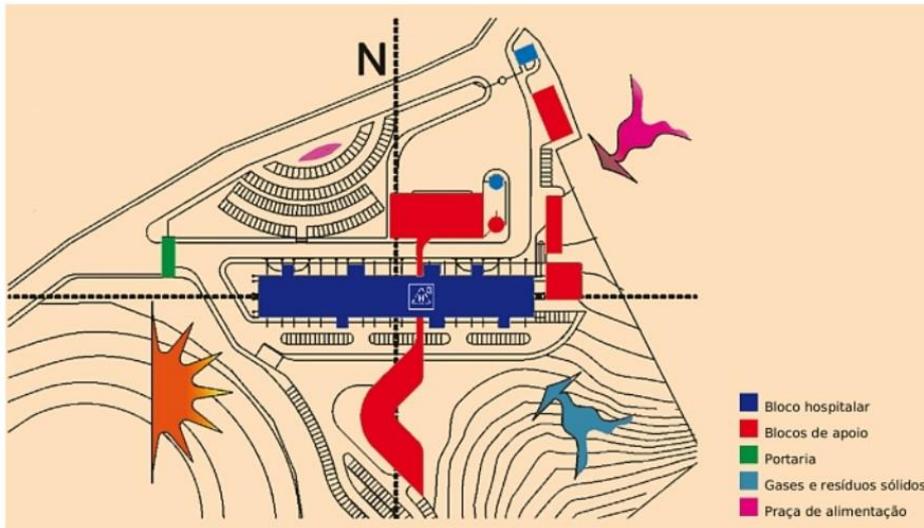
Implantação esquemática de setorização. Fonte: (web site Arco Web, 2011).
